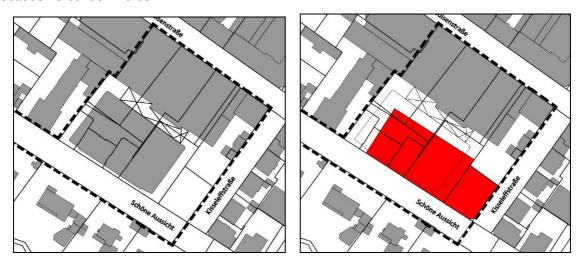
Lageplan mit Bestand (links) und mit Parkhausneubau (rechts)
